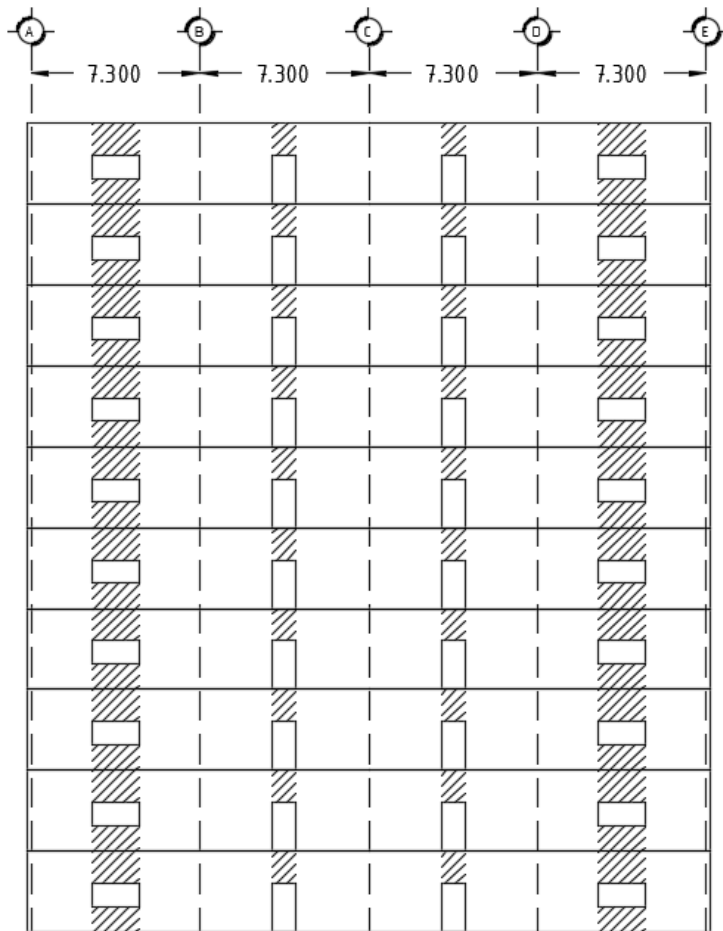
Elevación de paredes en ejes 1 y 4 para el edificio de 10 niveles. Las partes achuradas son vigas de acople (medidas en metros).
